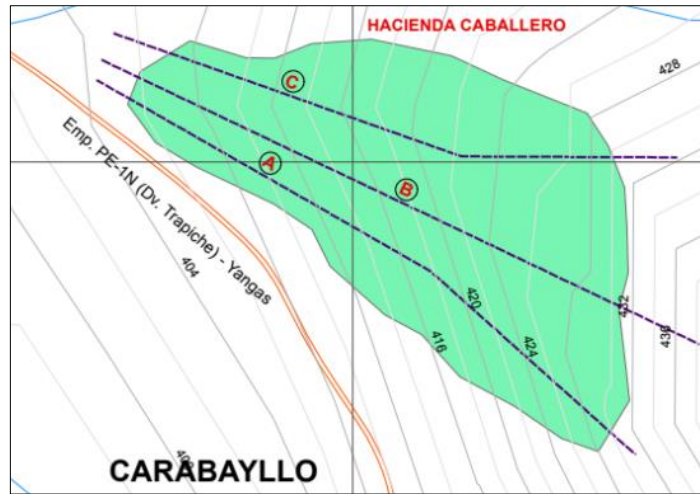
Vista en planta de los cortes de los perfiles longitudinales
